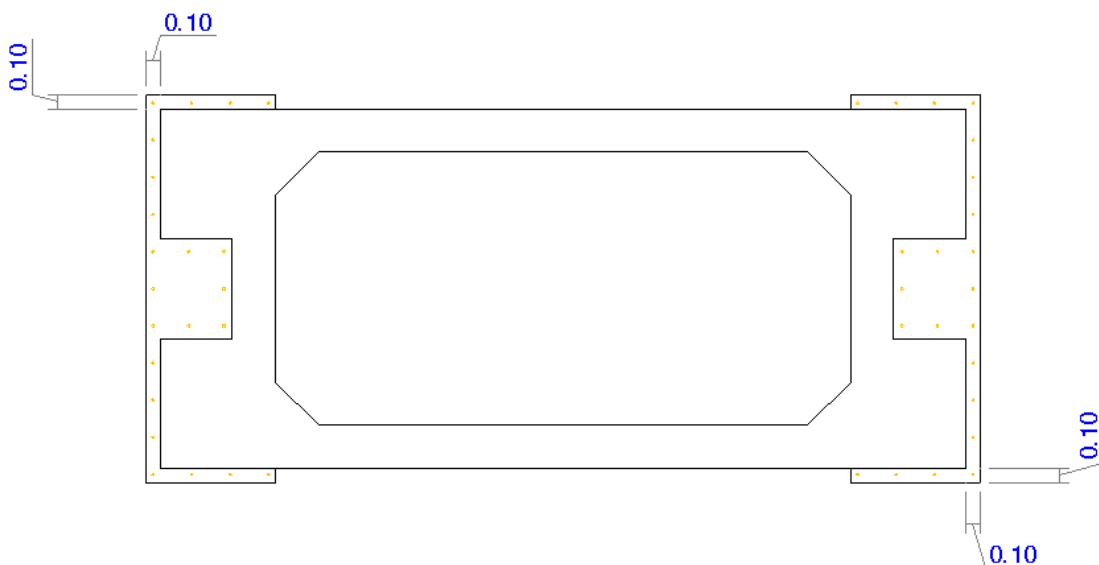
Rinforzo della sezione 1, nel cambio di sezione della pila 7;
